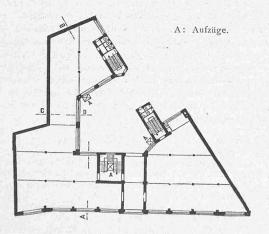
Erdgeschoss Grundriss 1:800.
